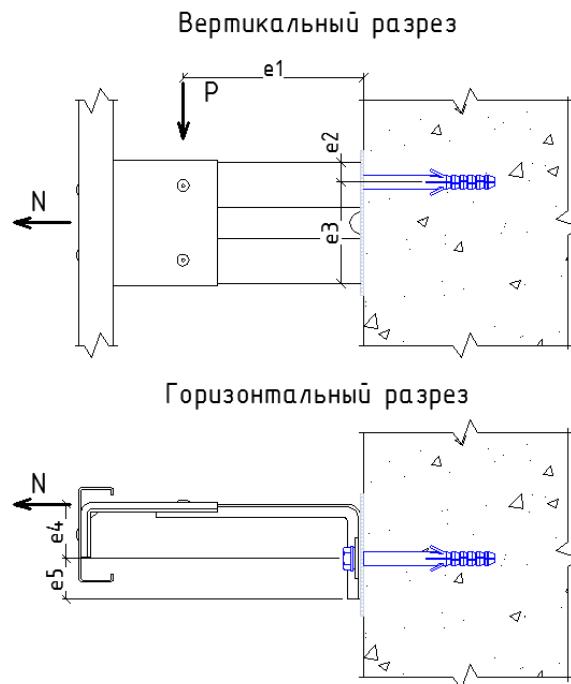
Расчётная схема проверки анкерного элемента на вырыв
